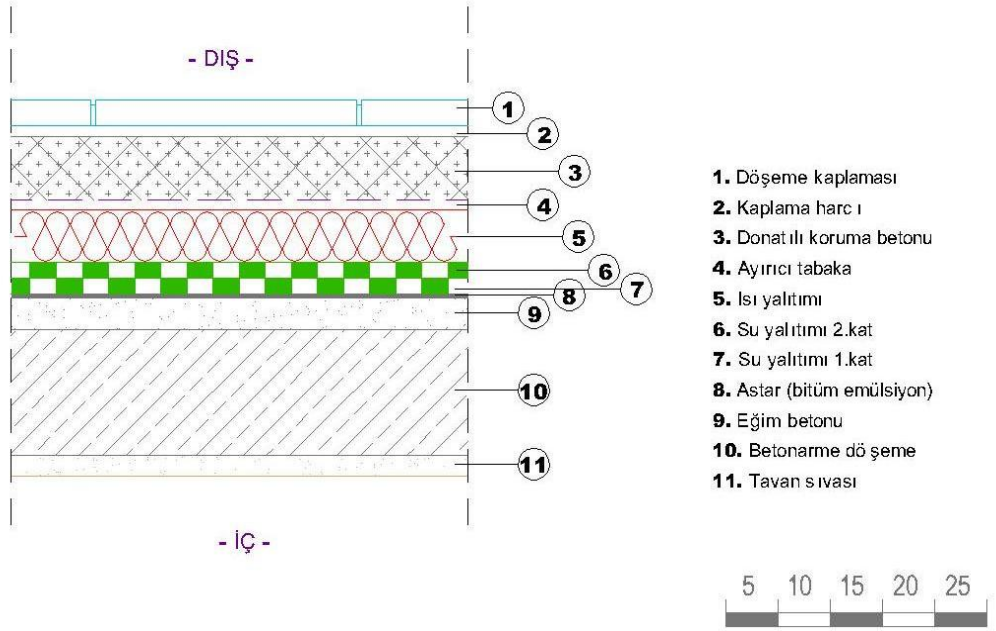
Yürünen Teras Çatılar - Detay B1
